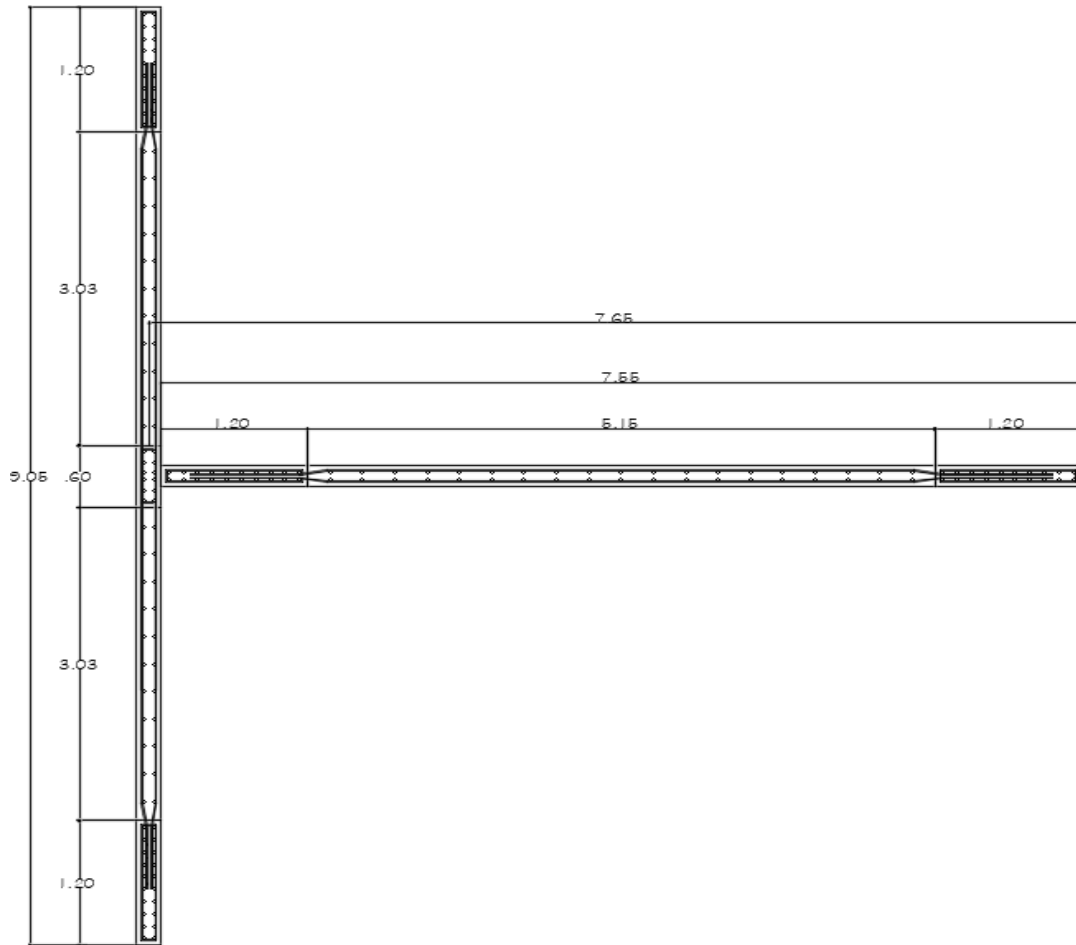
Detalle del refuerzo de los muros, PIER A. Extraída de ETABS.
